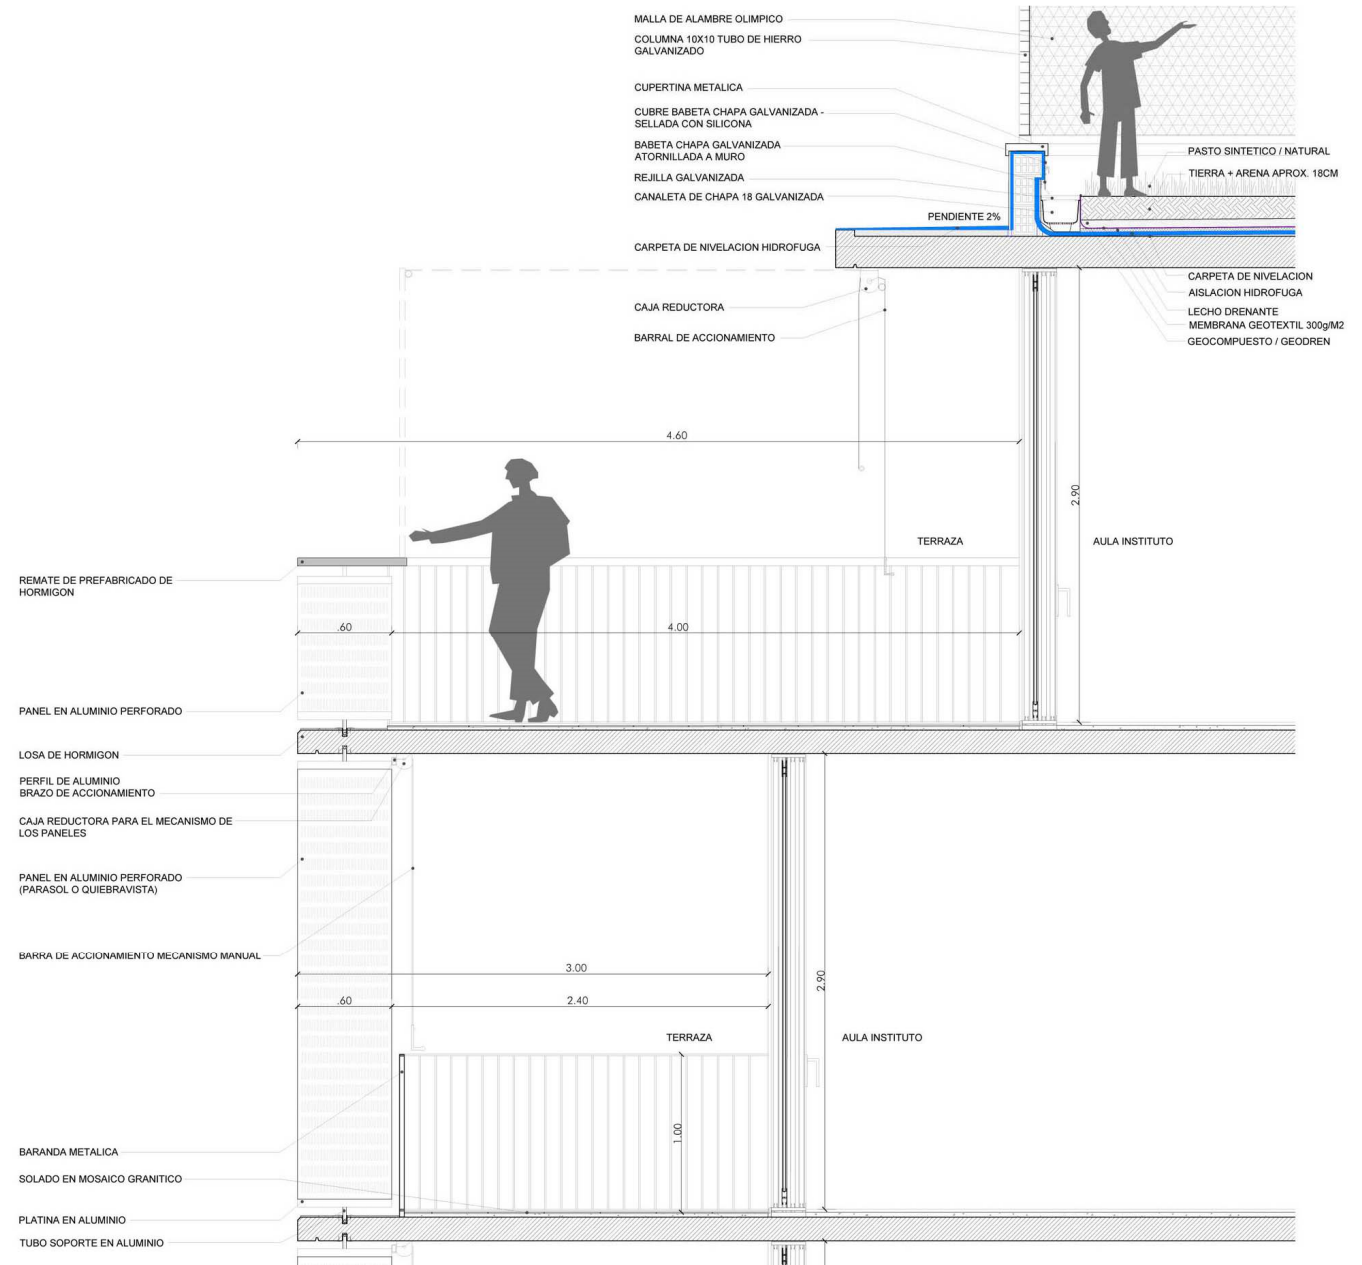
Detalle Corte fachada Escuela Primaria (Frente Holmberg)
